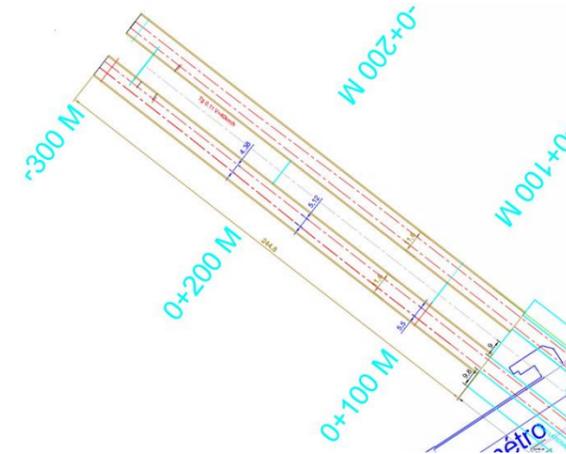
Vue en plan du génie civil prévu pour le corps principal de la gare
